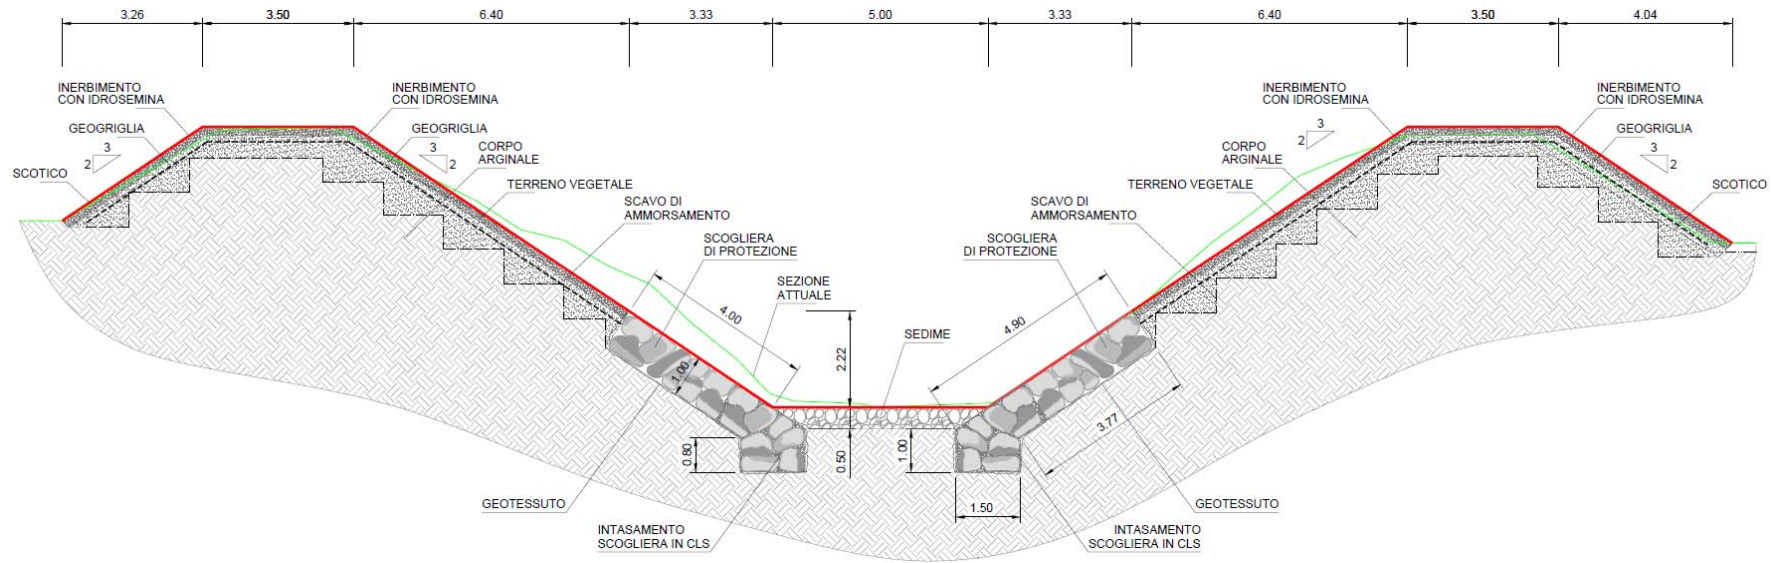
Sezione tipo intervento torrente Brana progetto preliminare [4] (scala 1:200).
